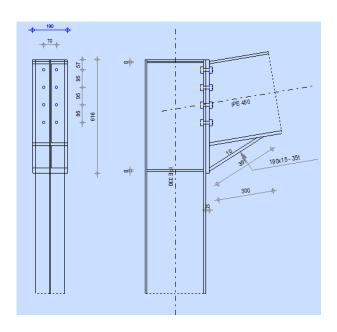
Schéma d'assemblage (poteau-traverse)
